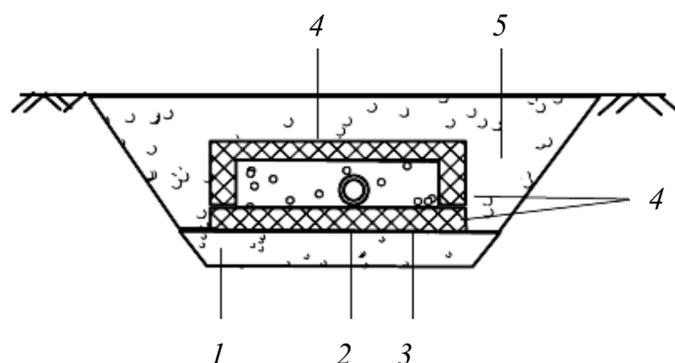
Теплоизоляция трубопровода: 1 – песчаная или гравийная подсыпка толщиной 100 мм; 2 – изолируемые трубы; 3 – песчано-гравийная смесь толщиной 100 мм; 4 – экструдированный пенополистирол; 5 – засыпка песком, гравием или грунтом [2]
